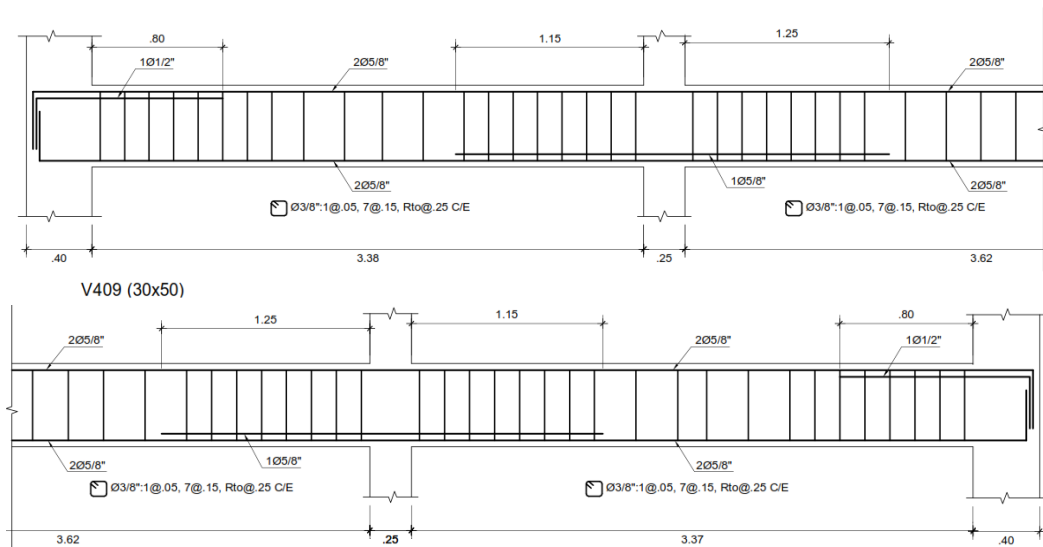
Refuerzo final en viga V409 de edificación con disipadores
